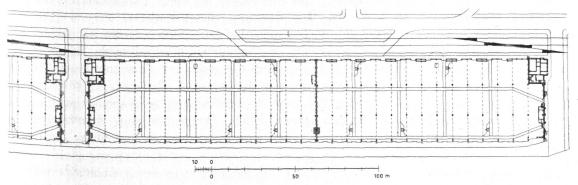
Raischuppen 53 am Bremer Rai, Grundrig.
